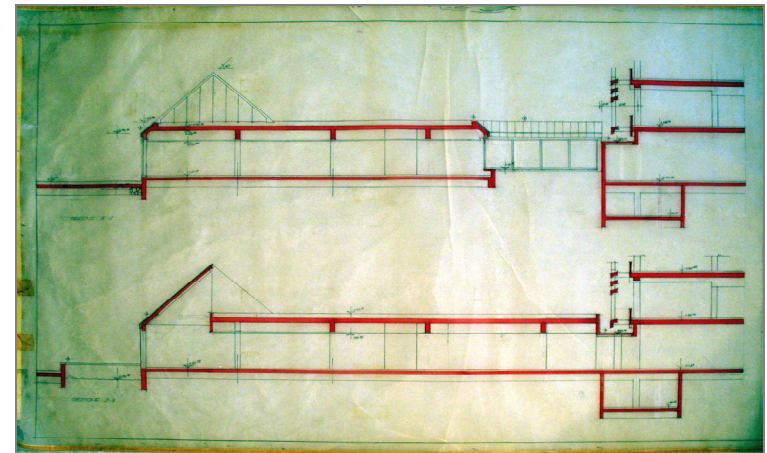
sezione del volume interno al cortile (fonte CSAC – stralcio tav. 52, archivio n. 384-5)
